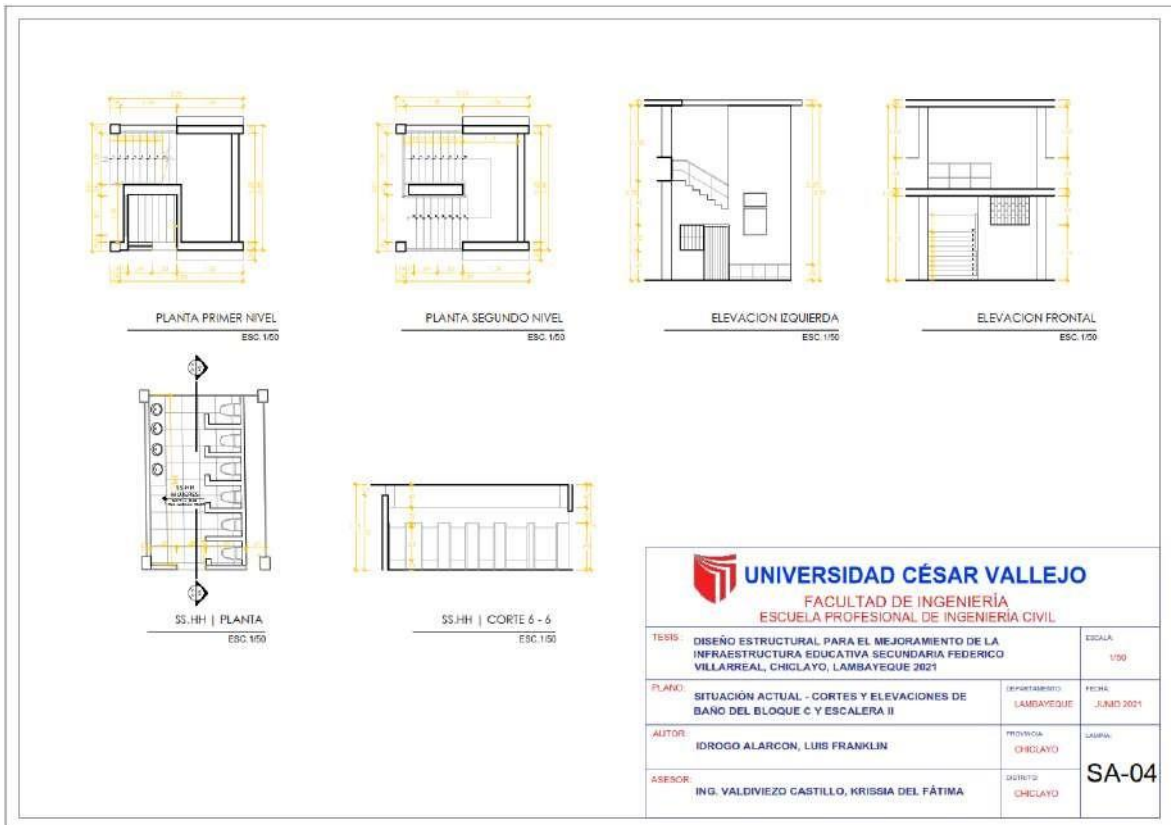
Plano SA-04: Situación Actual - Cortes y elevaciones de baño del Bloque C y escalera II, 17-06-2021.
